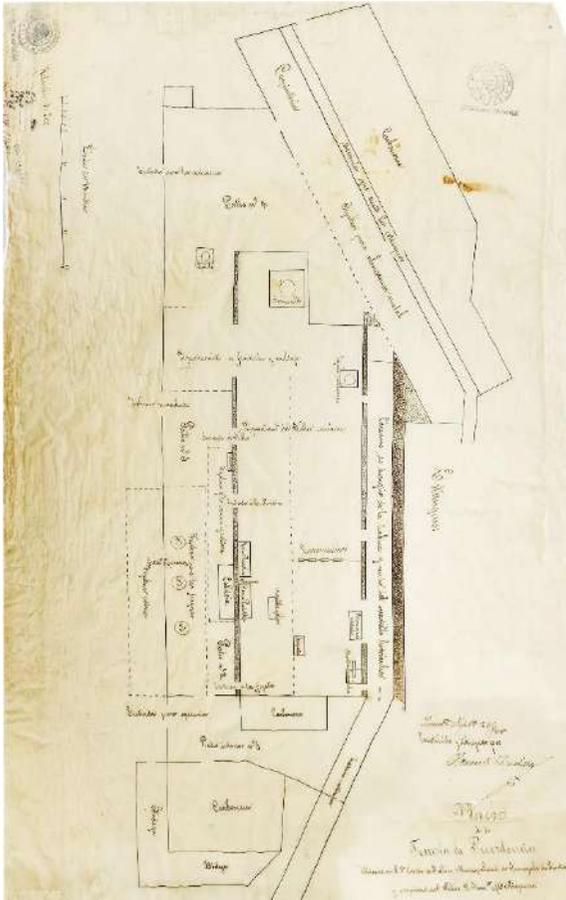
Plano de la Ferrería de la Providencia. Fuente: Archivo Histórico de Jalisco.PL.5.3-1900-176 INV-138. (1900).
